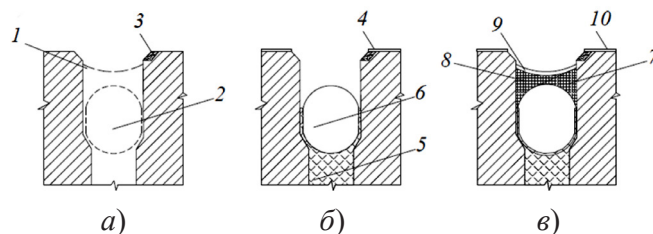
Устройство «теплых» швов наружных стеновых панелей: *а* – разборка гидроизоляции и герметика; *б* – утепление шва; *в* – герметизация шва; 1 – разборка герметика; 2 – снятие прокладки; 3 – ремонт граней; 4, 10 – наклейка и снятие малярной ленты; 5 – заполнение полости шва монтажной пеной; 6 – установка уплотняющей прокладки; 7–9 – послойное нанесение герметизирующей мастики
